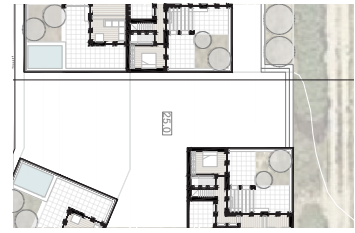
Planta e corte remate de rua de distribuição 1:1000
